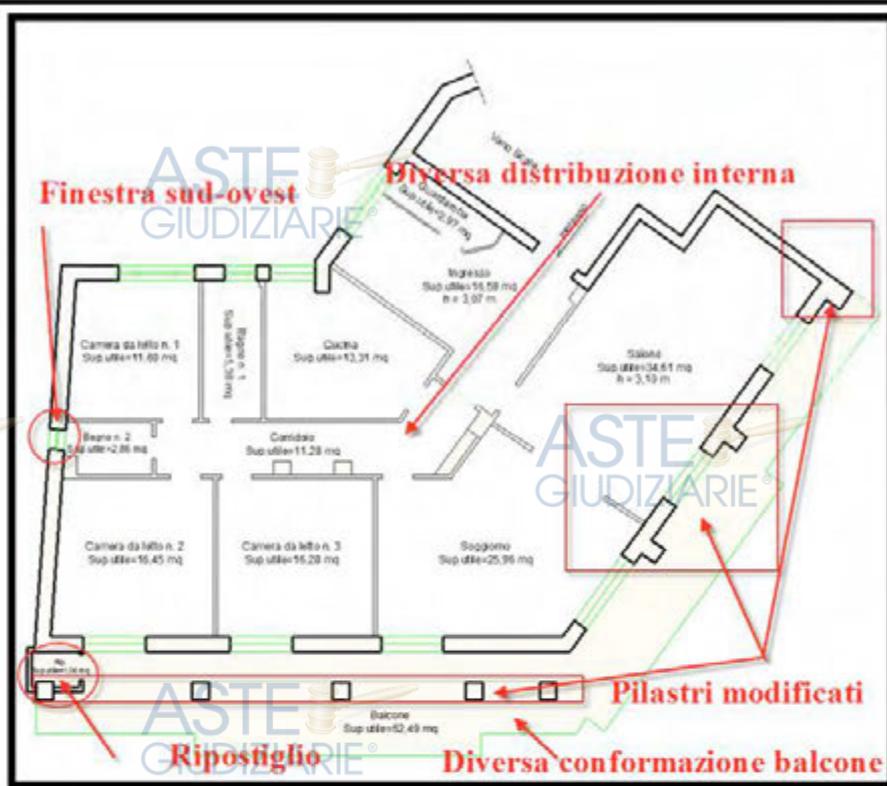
Rilievo appartamento – Piano Quarto (Attico)
